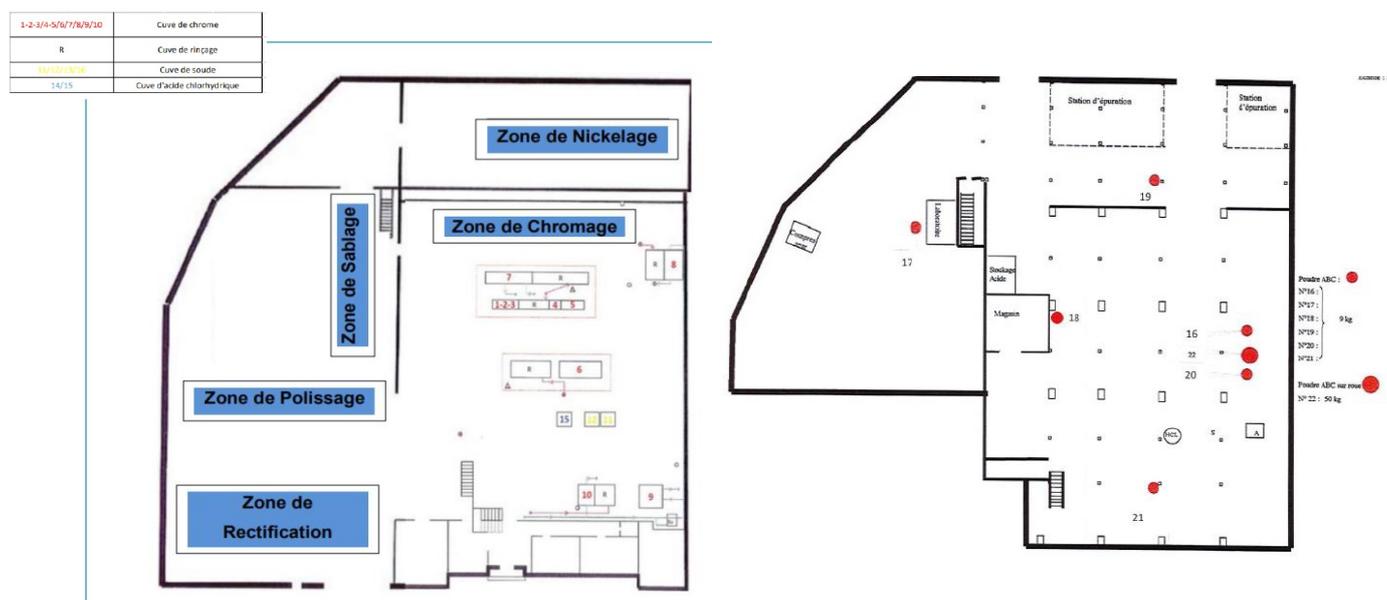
Plan des deux étages du bâtiment, à gauche le rez-de-chaussée et à droite le sous-sol (Source : dossier)
